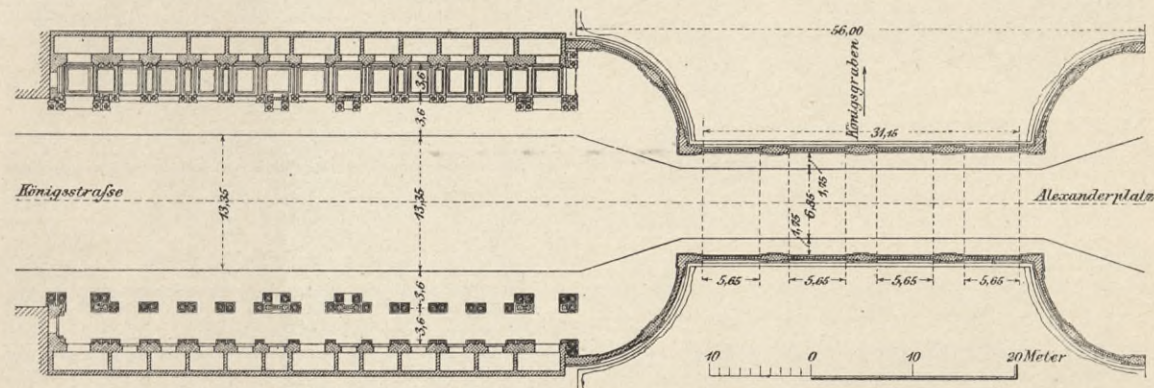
Lageplan der Königs-Brücke und der Königs-Kolonnaden.
